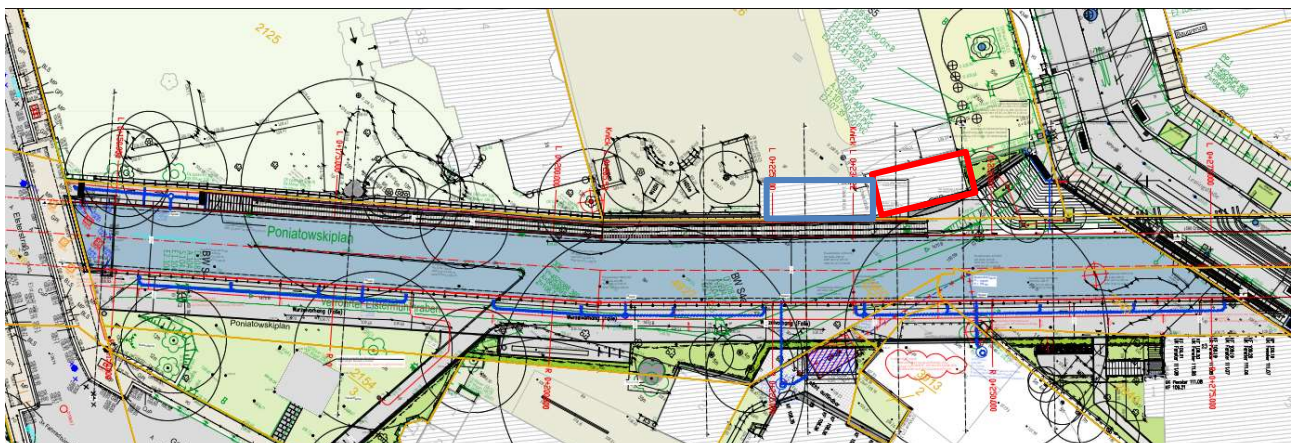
Lageplan Objektplanung [U1] mit Darstellung des Mädchen-WC (rot) und Jungen-WC (blau) auf dem Grundstück der Lessingschule
